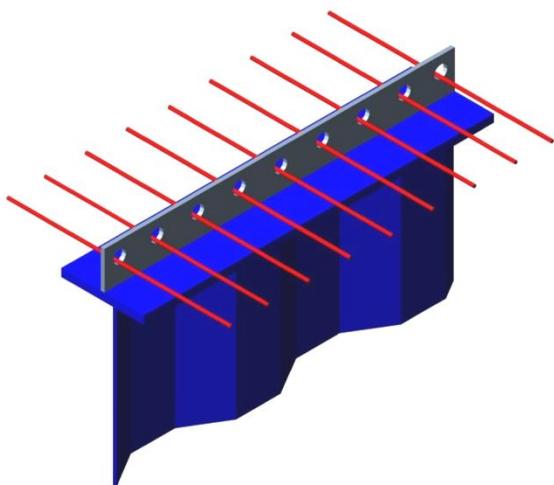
Verbundfuge mit Stahloberggurt und einreihig Betondübel
